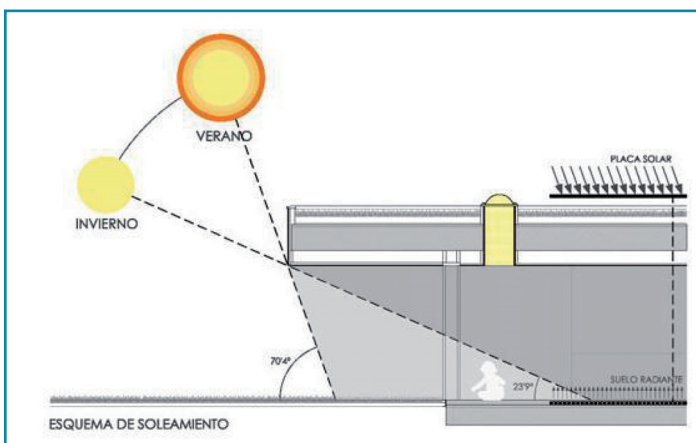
Esquema de Soleamiento. Guardería en Viladecans, 2006.
